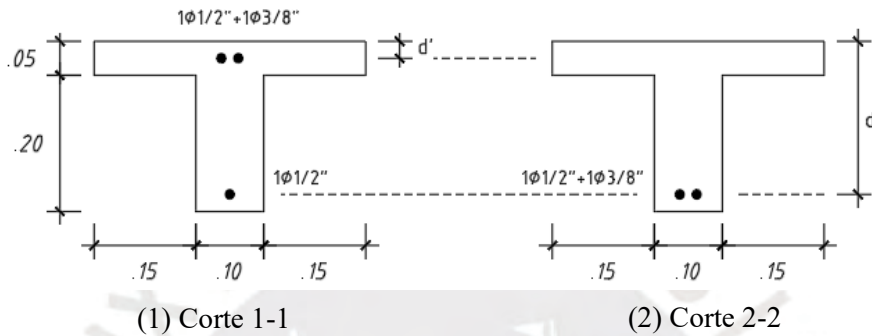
Detalle de las secciones críticas del aligerado AD/3-4.
